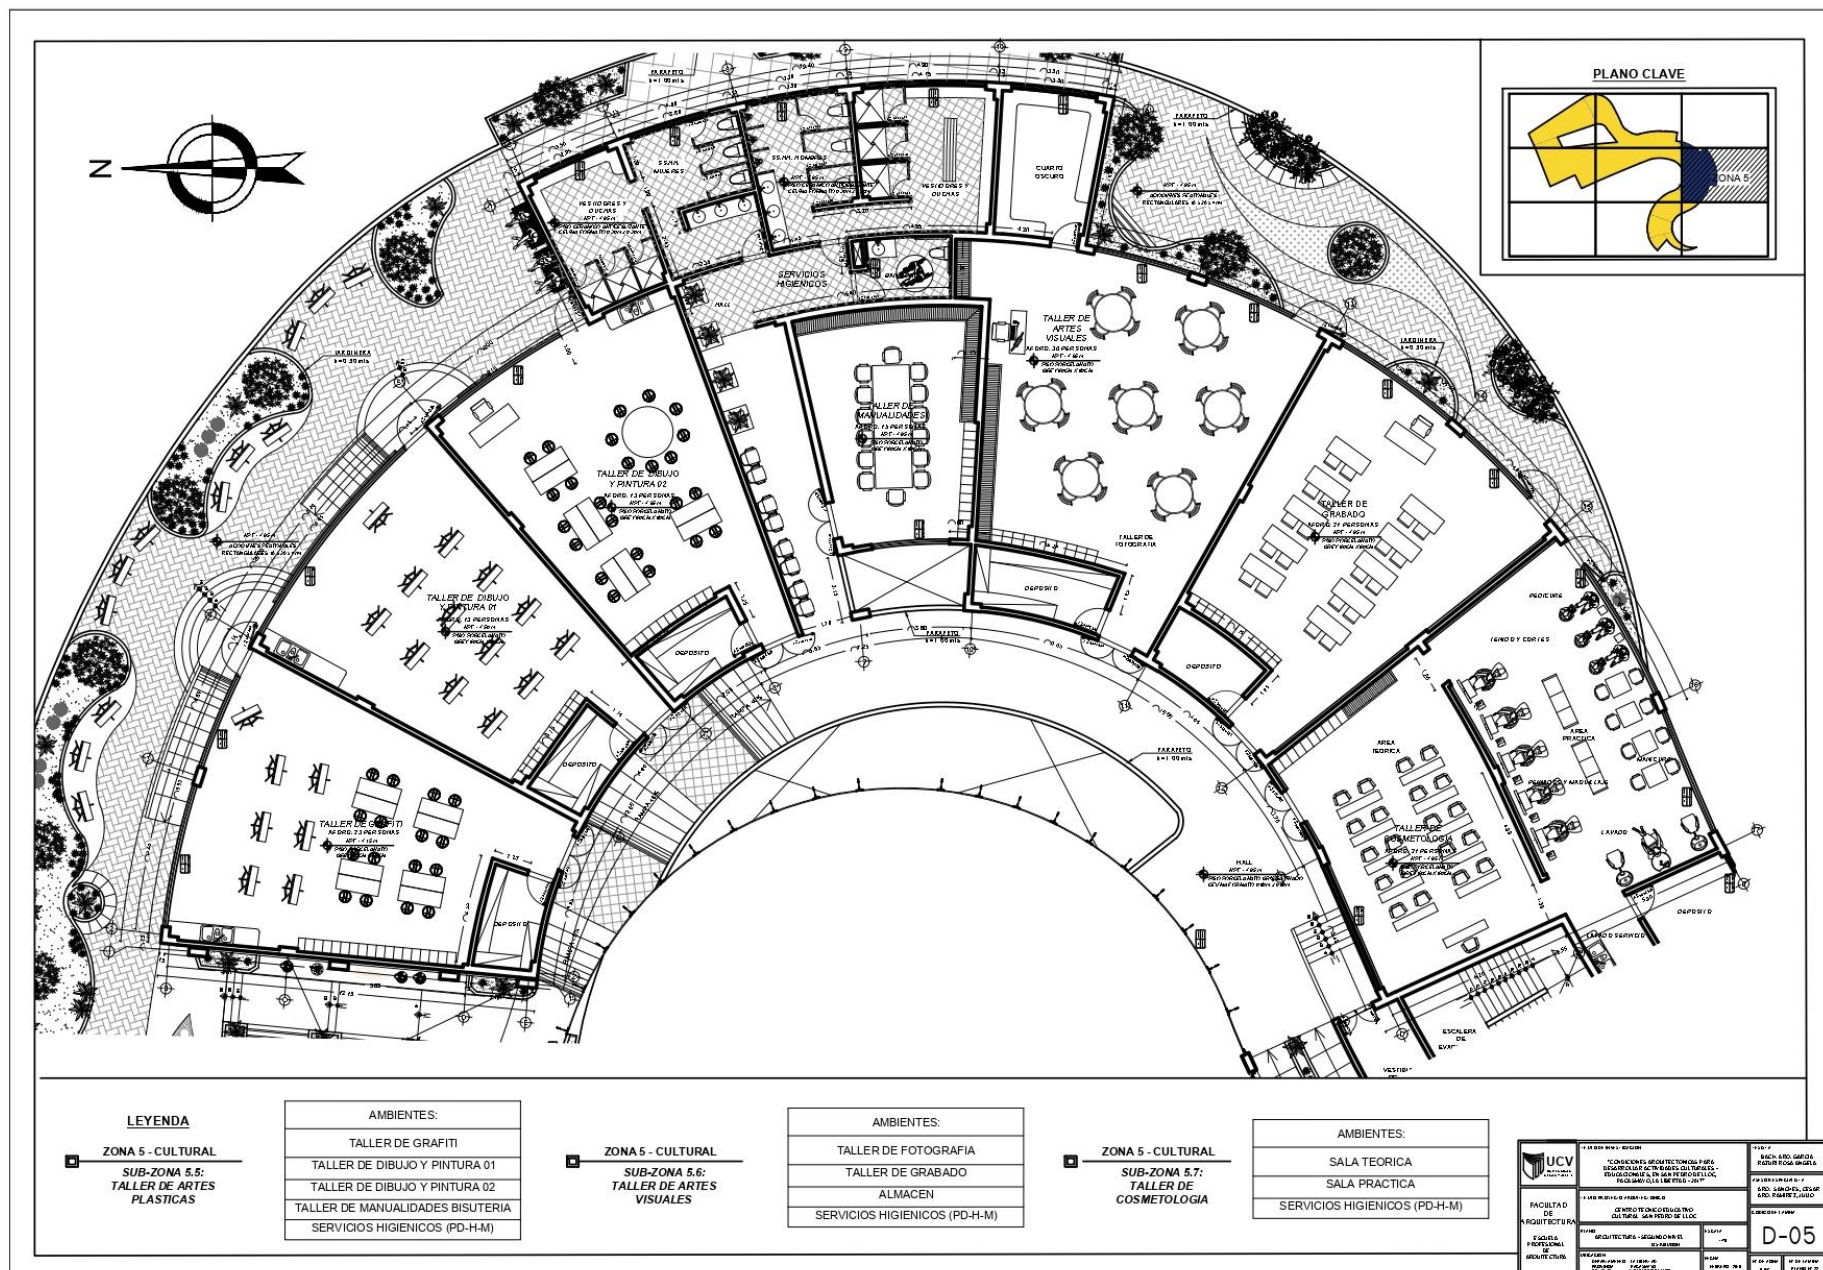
Plano de Desarrollo por Zonas - Plano N° 22 - Lamina N°: D - 05
